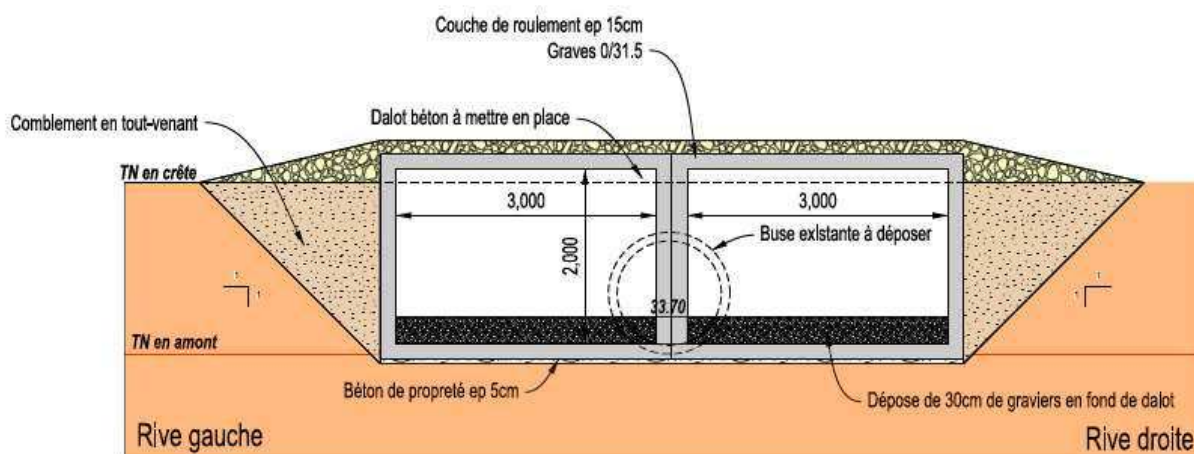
coupe du double dalot sur le secteur de Moulin Jasnot/Pont des Planches
